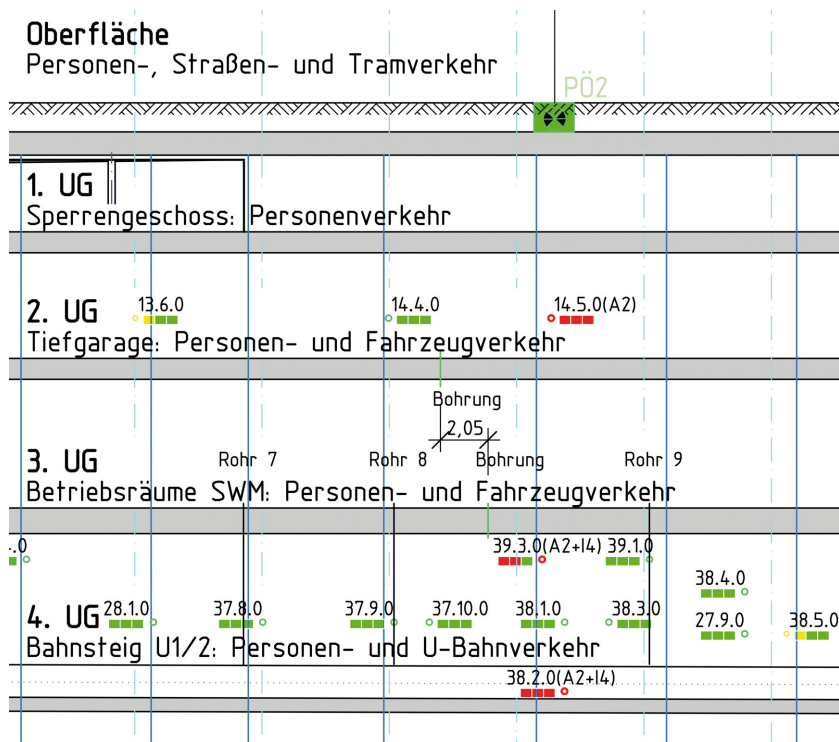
Ausschnitt aus dem Plan der Kartierung der Chloridproben (Schlitzwand West HU)
